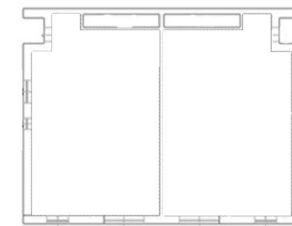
Pianta piano terra; Fonte: M. Cerula, et. al., 2011;
